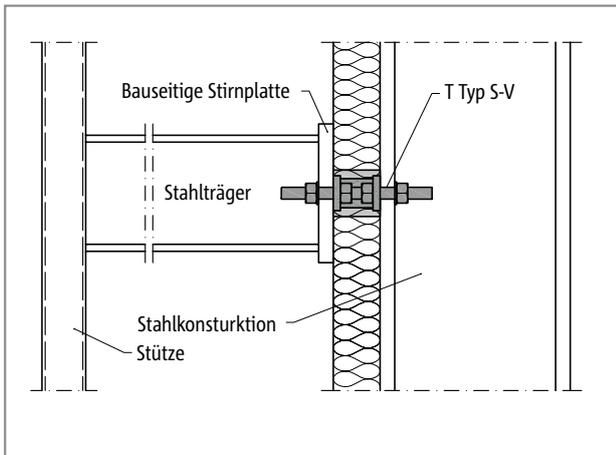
Schöck Isokorb® T Typ S-V: Stahlkonstruktion gestützt
